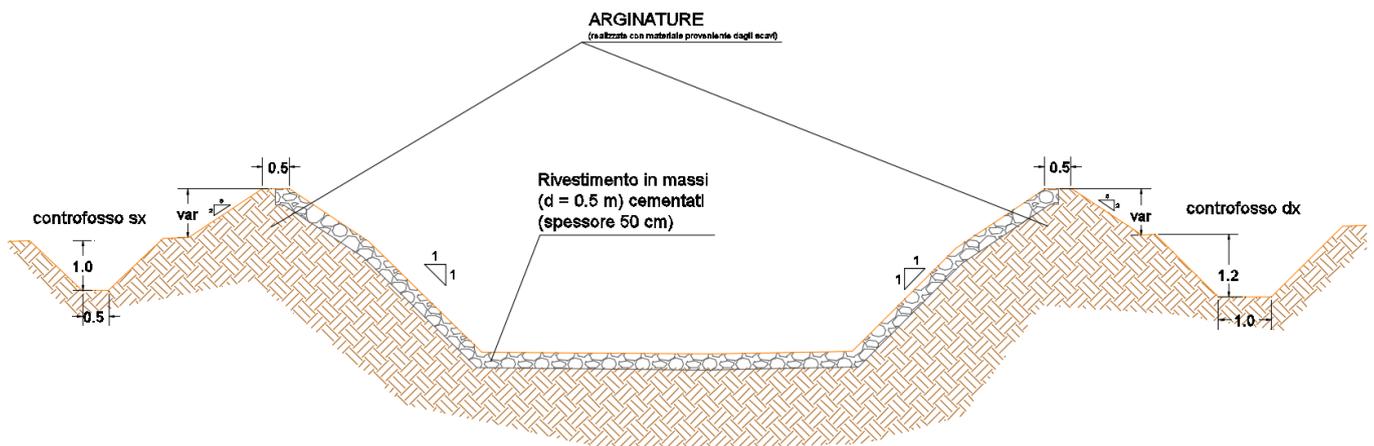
Fiume Grande: opere di sistemazione idraulica, sezione tipo.
